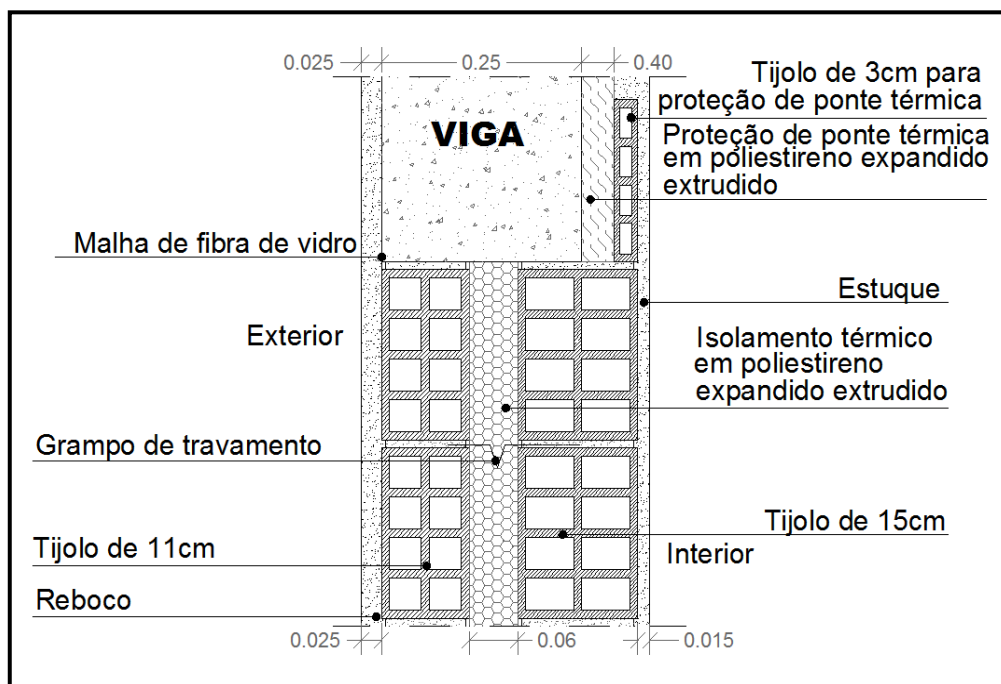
Pormenor da parede exterior de pano duplo e viga, em corte (Pe1 e PTPe1)
